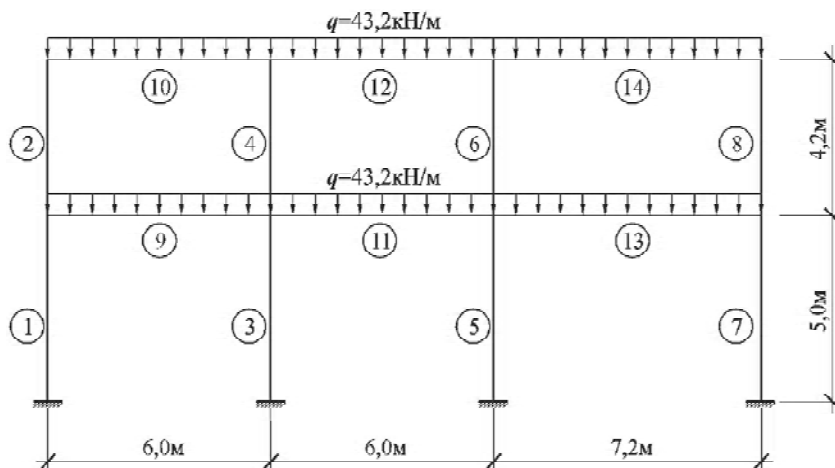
Расчетная схема каркаса здания на втором этапе расчета.
